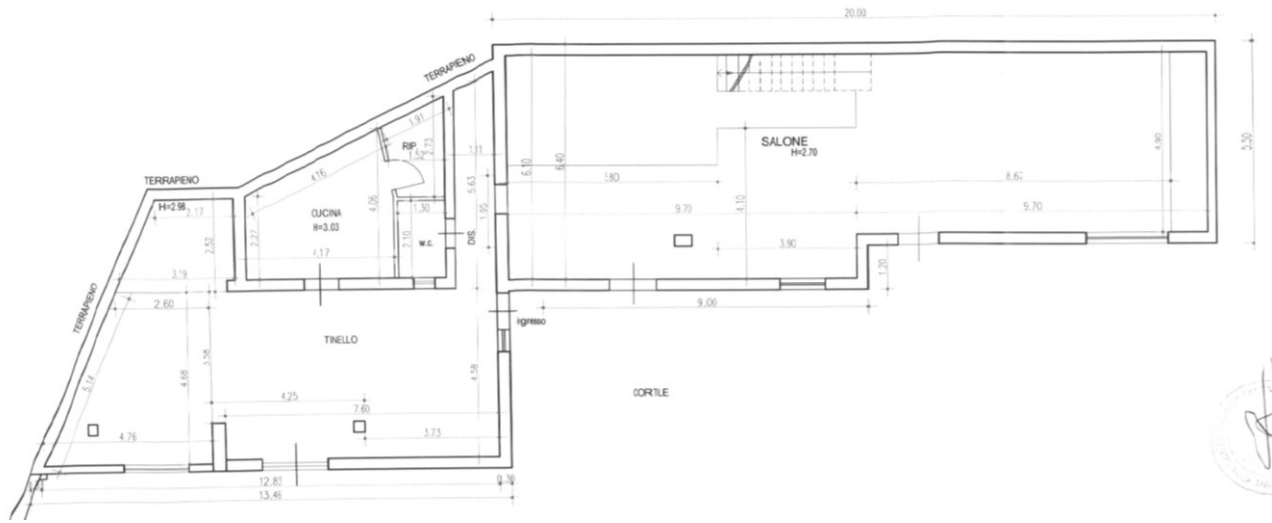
planimetria urbanistica del piano terra della villa secondo il P.d.C. n.70/2022
